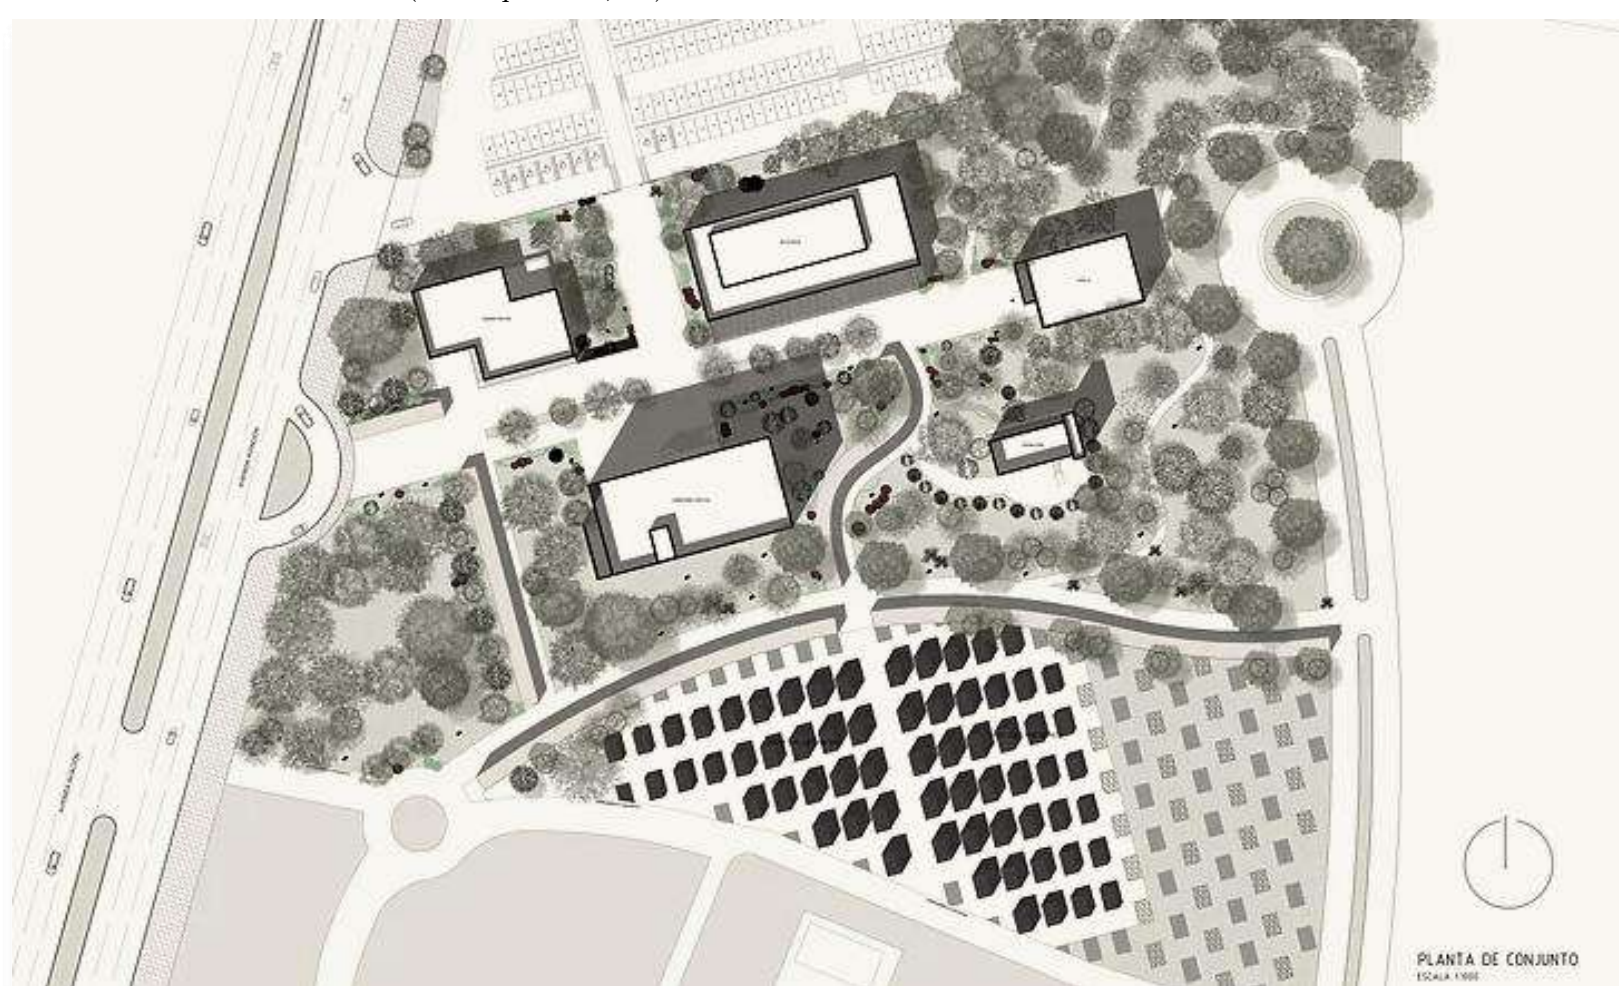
Vistas en planta del Cementerio Mixto. (JM Arquitectos, s.f.)
